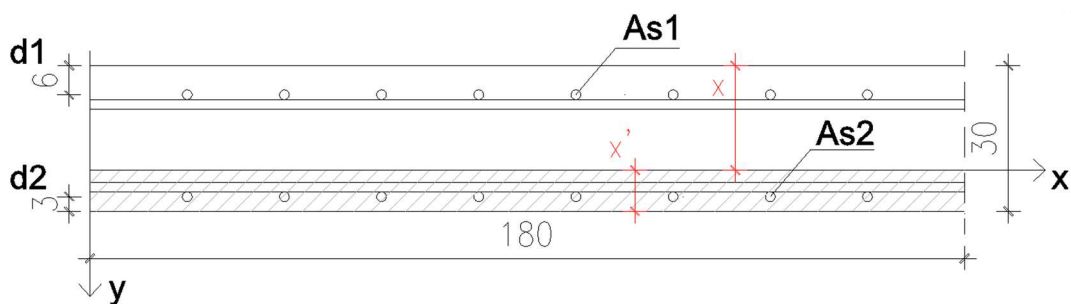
Sezione trasversale soletta all'appoggio, quote in cm
